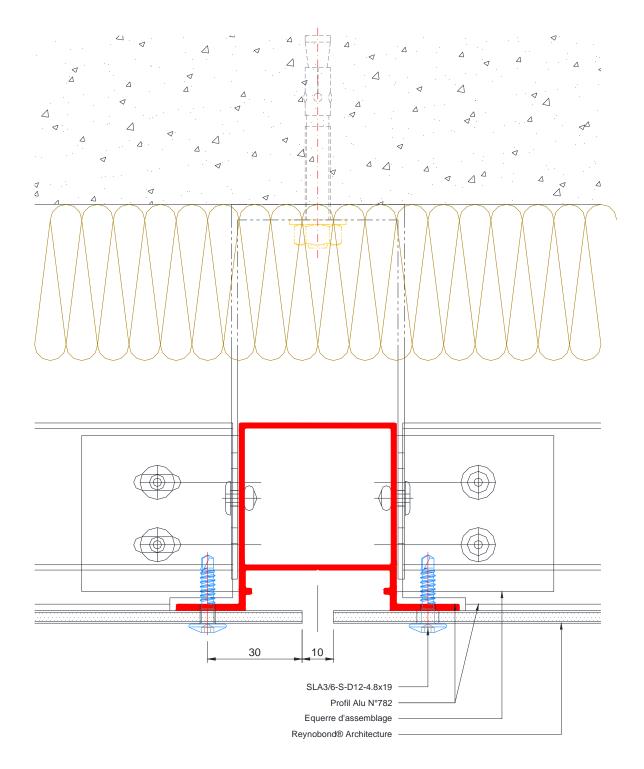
is – Joint vertical - Coupe horizontale - Système vissé SC 60 4c
